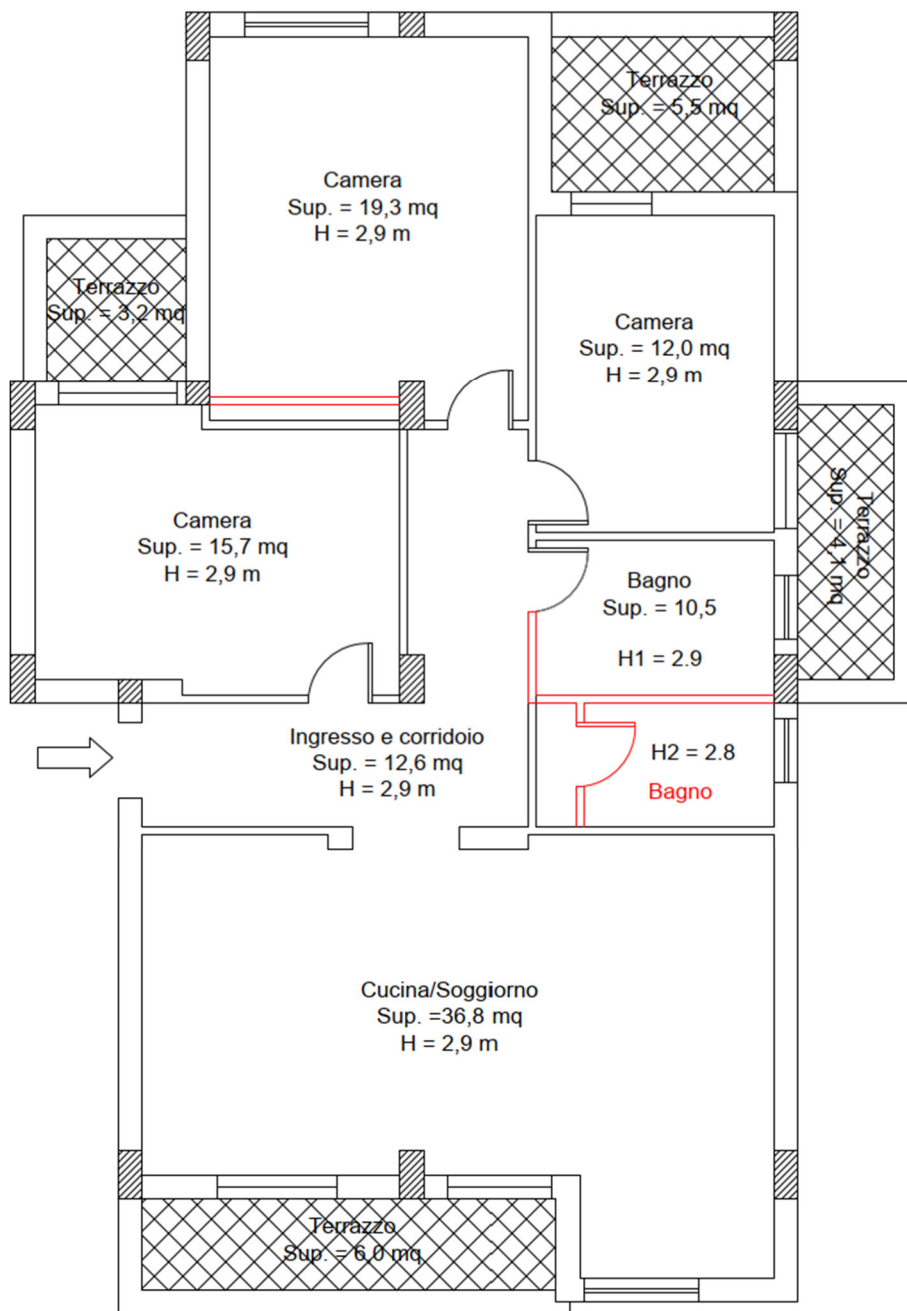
Planimetria stato di fatto vs planimetria catastale
